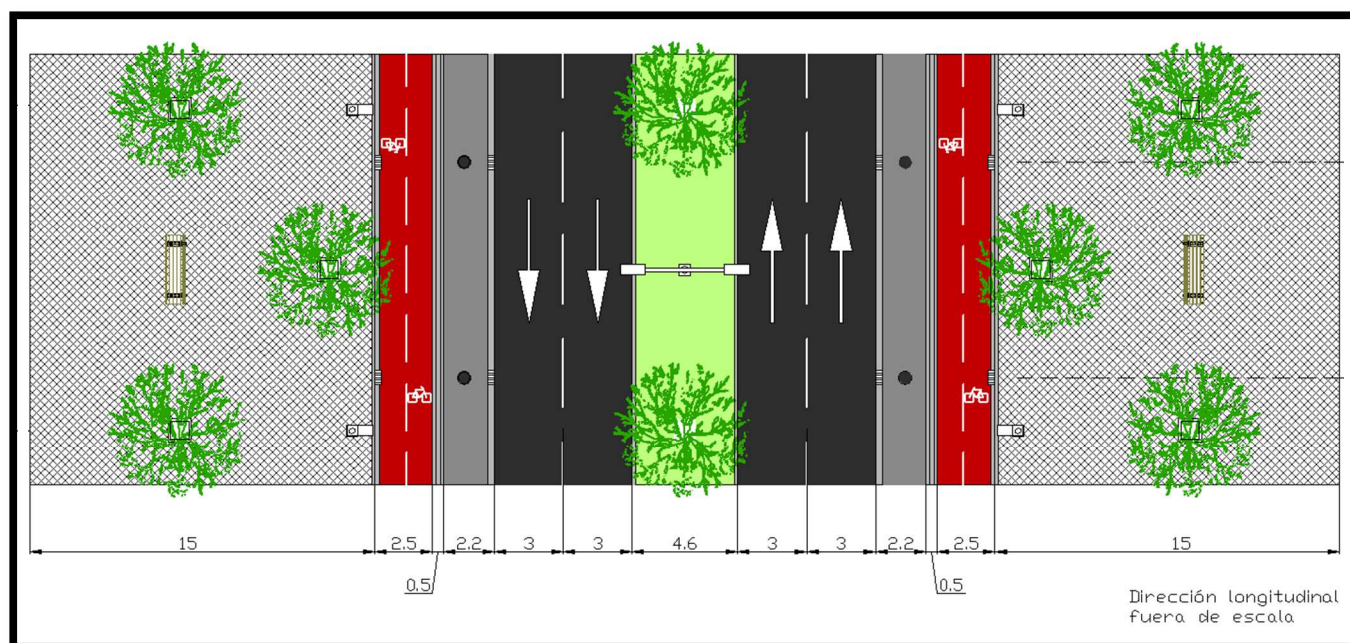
Planta explicativa de la alternativa 2 desarrollada en este anteproyecto.
